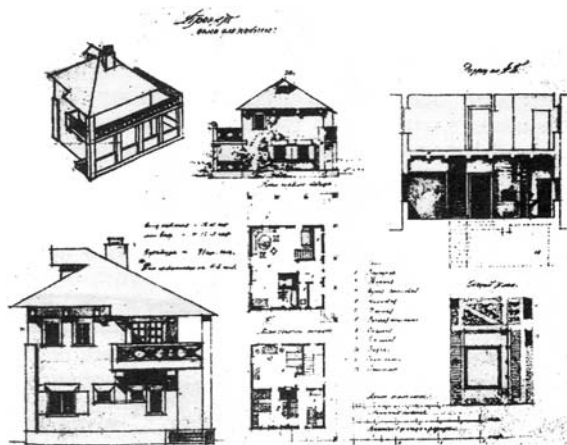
Проект дома для рабочих на одну семью. Начало 20-х годов. Перспектива, фасады, планы
